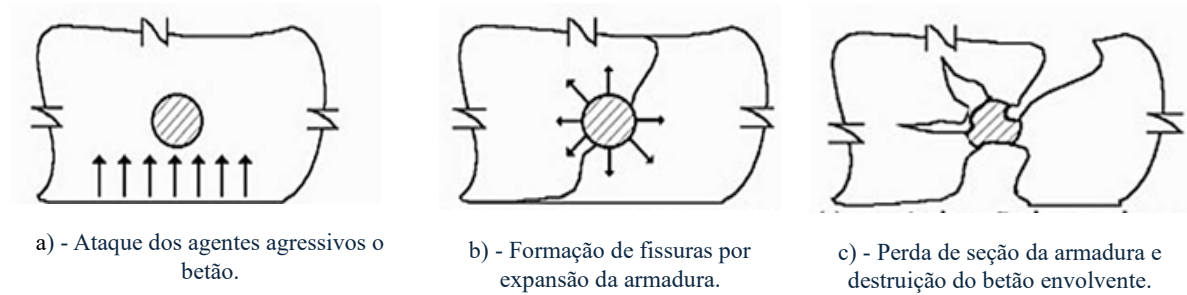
Fases da instalação do processo de corrosão das armaduras no betão (3).
